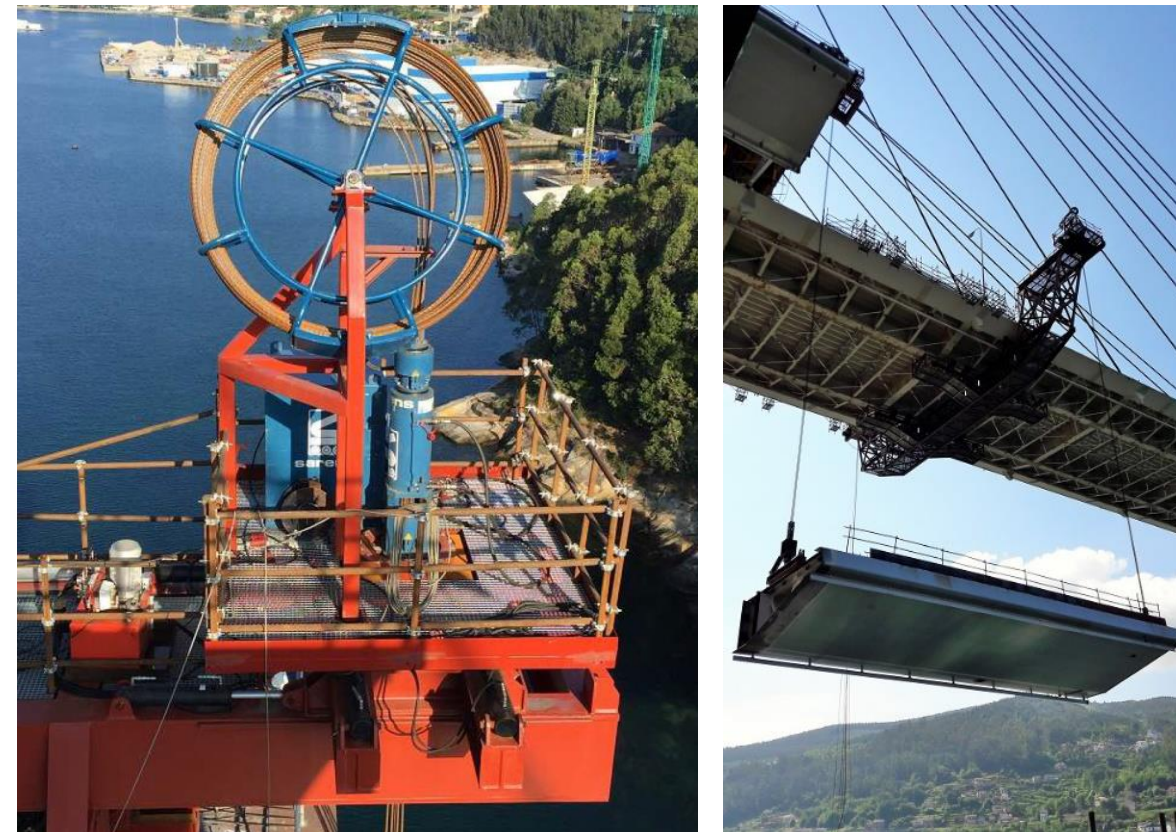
Sistema de izado mediante cables de "Heavy Lift"
